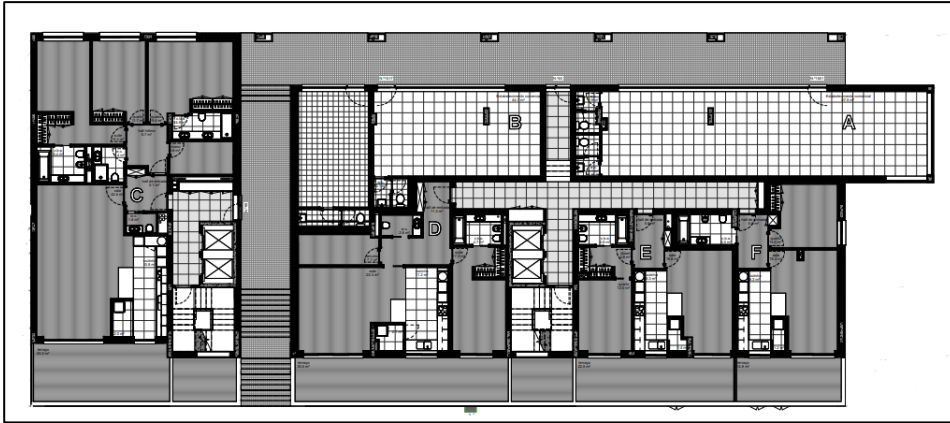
Recorte da planta de arquitetura do piso 0 do edifício Altavista 16 (1).
